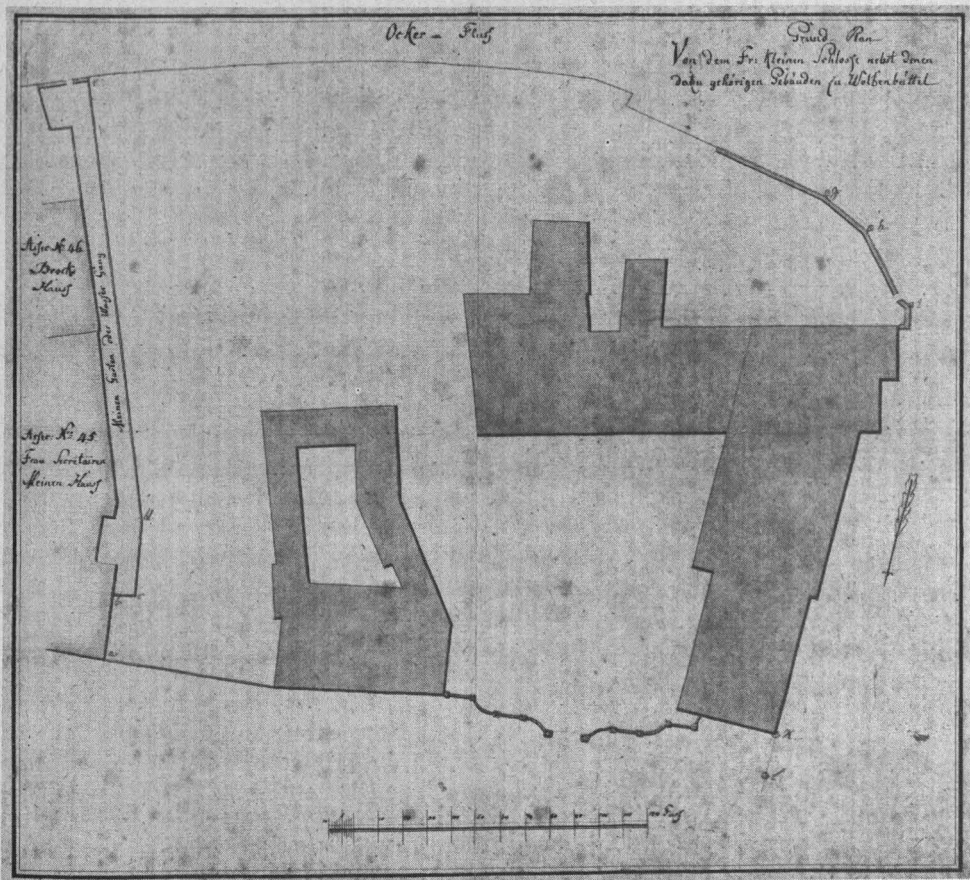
Grundplan von dem früheren Kleinen Schlosse nebst denen dazugehörigen Gebäuden zu Wolfenbüttel
